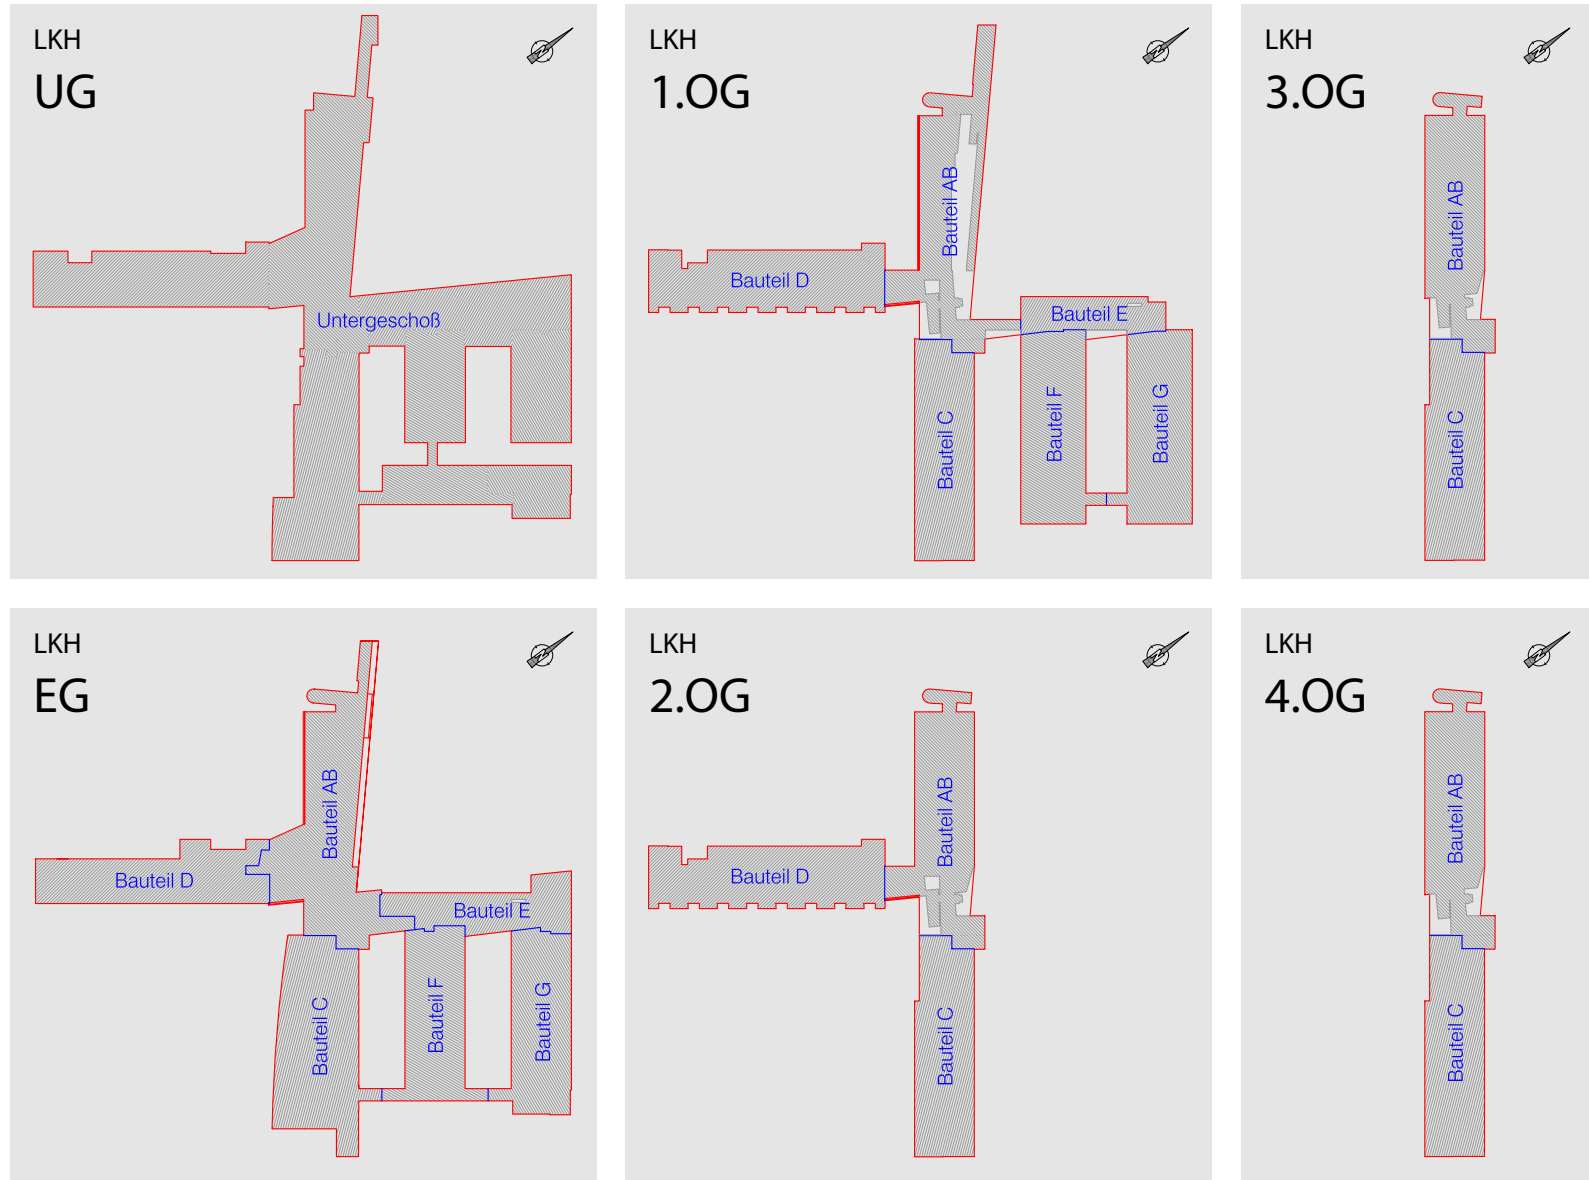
Zonierung LKH (Untergeschoß - 4. Obergeschoß)
